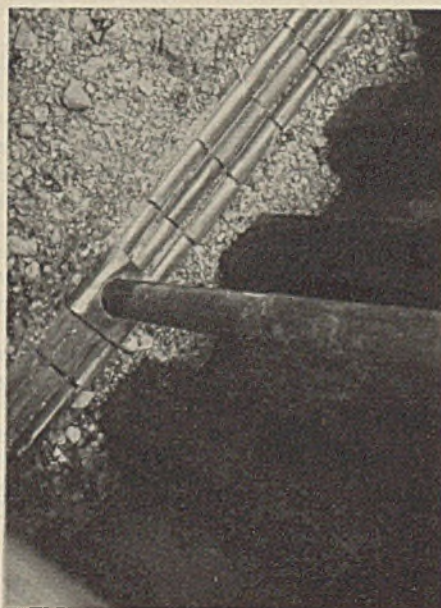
Randdränstrang mit Verfüllungsstandrohr.
